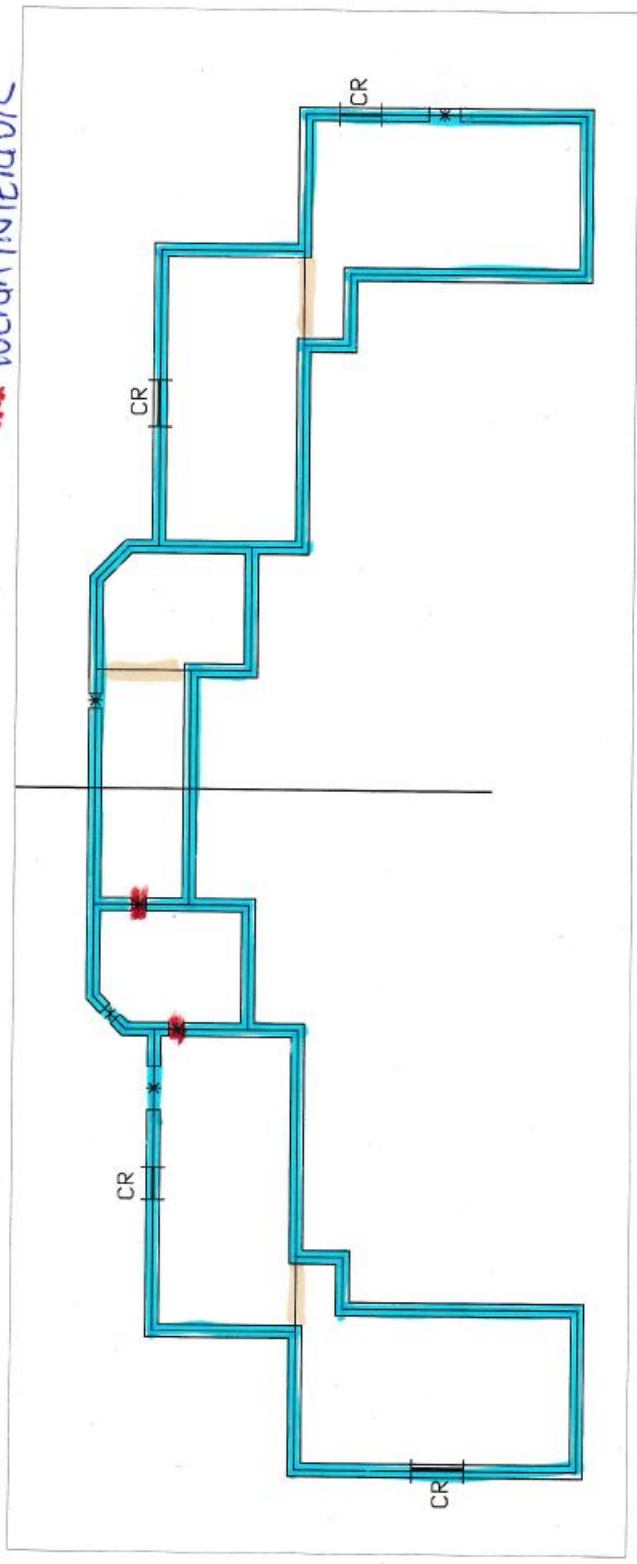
Distribución de muros, aberturas y puertas subterráneo.
